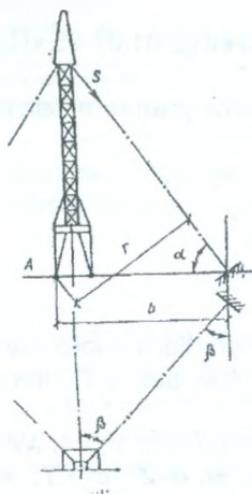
Расчетная схема усилий в растяжках крана
